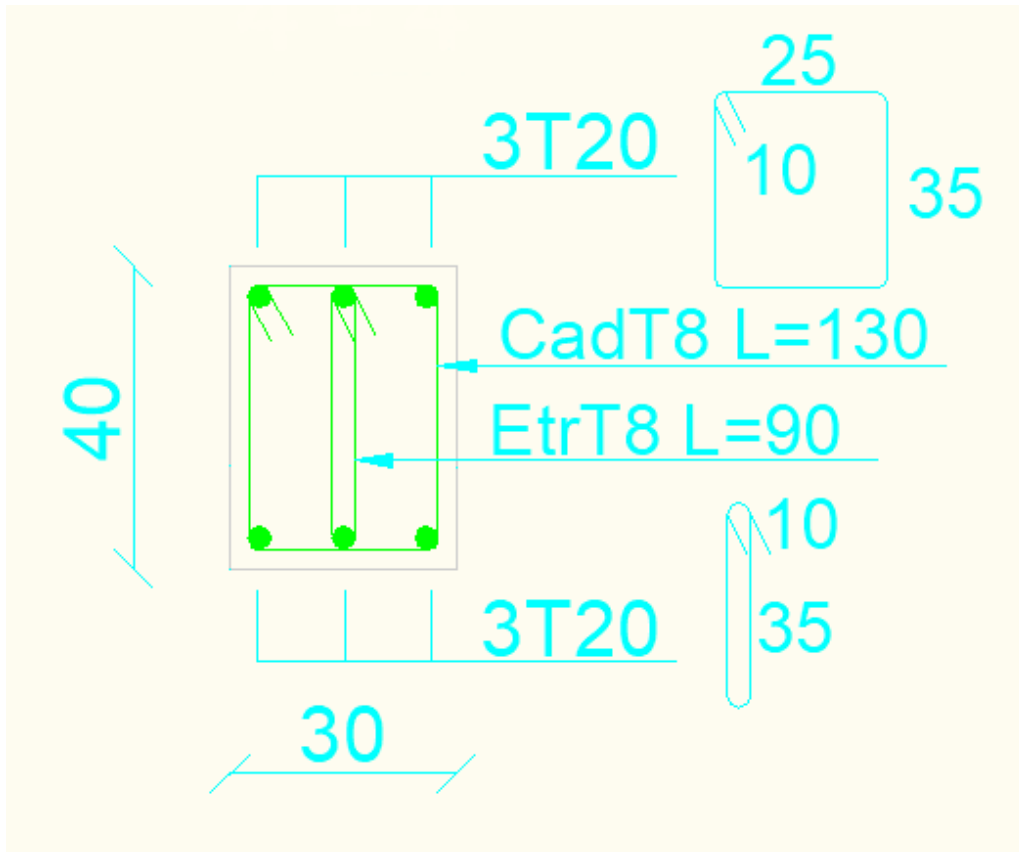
Schéma de ferrailage poutre secondaire Niv 6 en travée.
